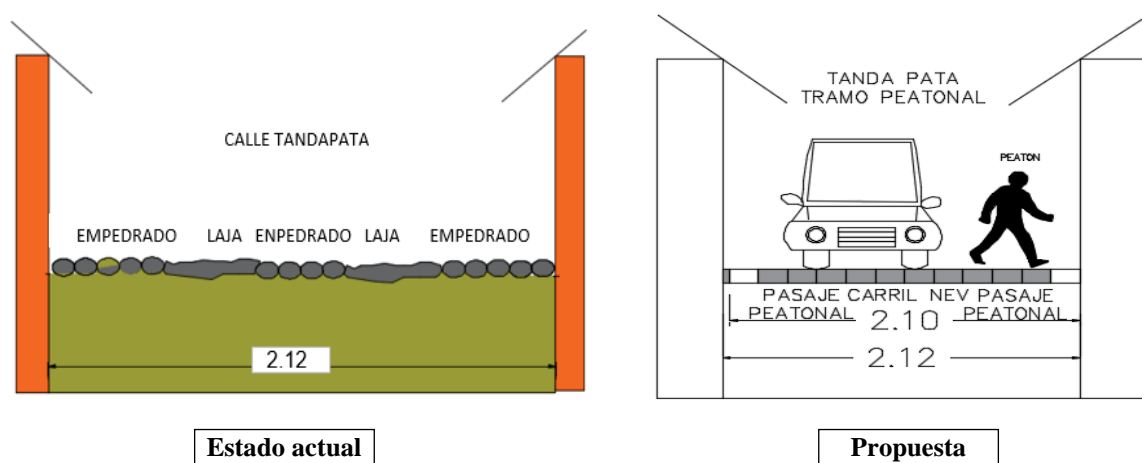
Propuesta de la sección transversal para la calle Tandapata
